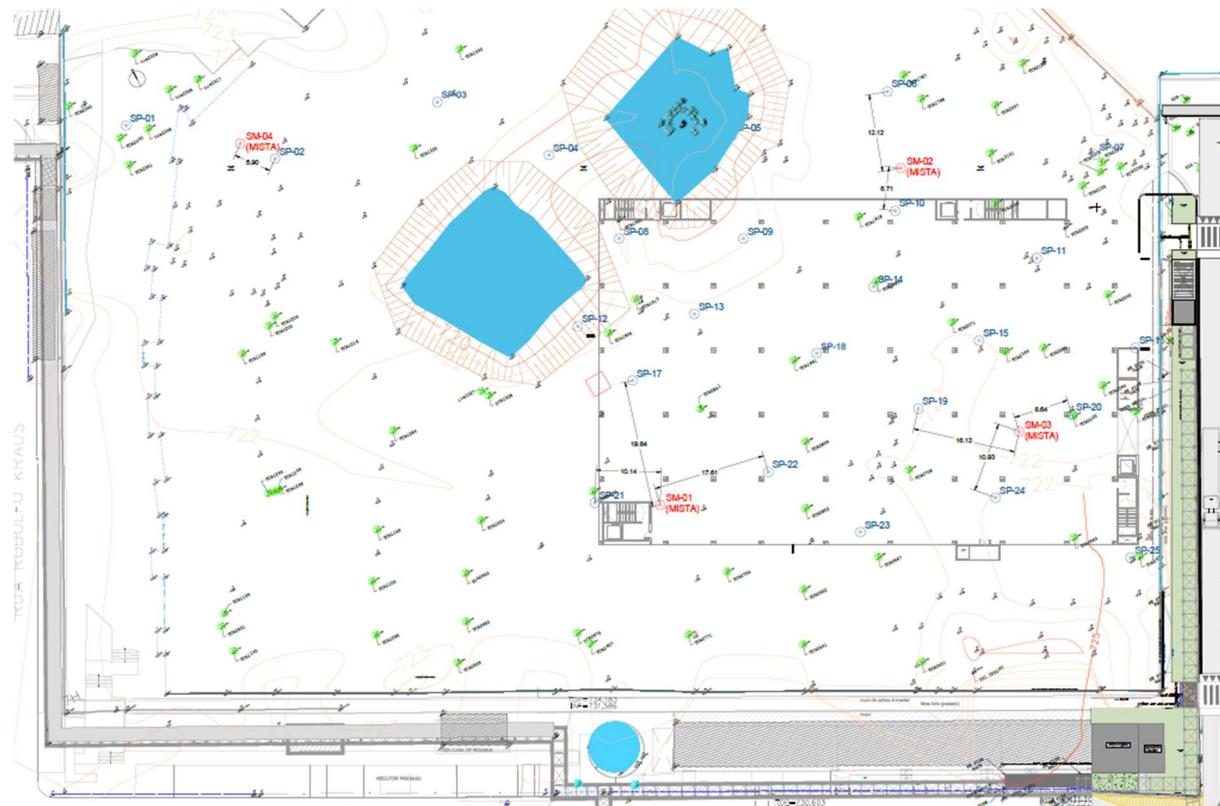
Planta de locação de pontos de sondagem à percussão (em azul) e sondagem mista (em vermelho).
